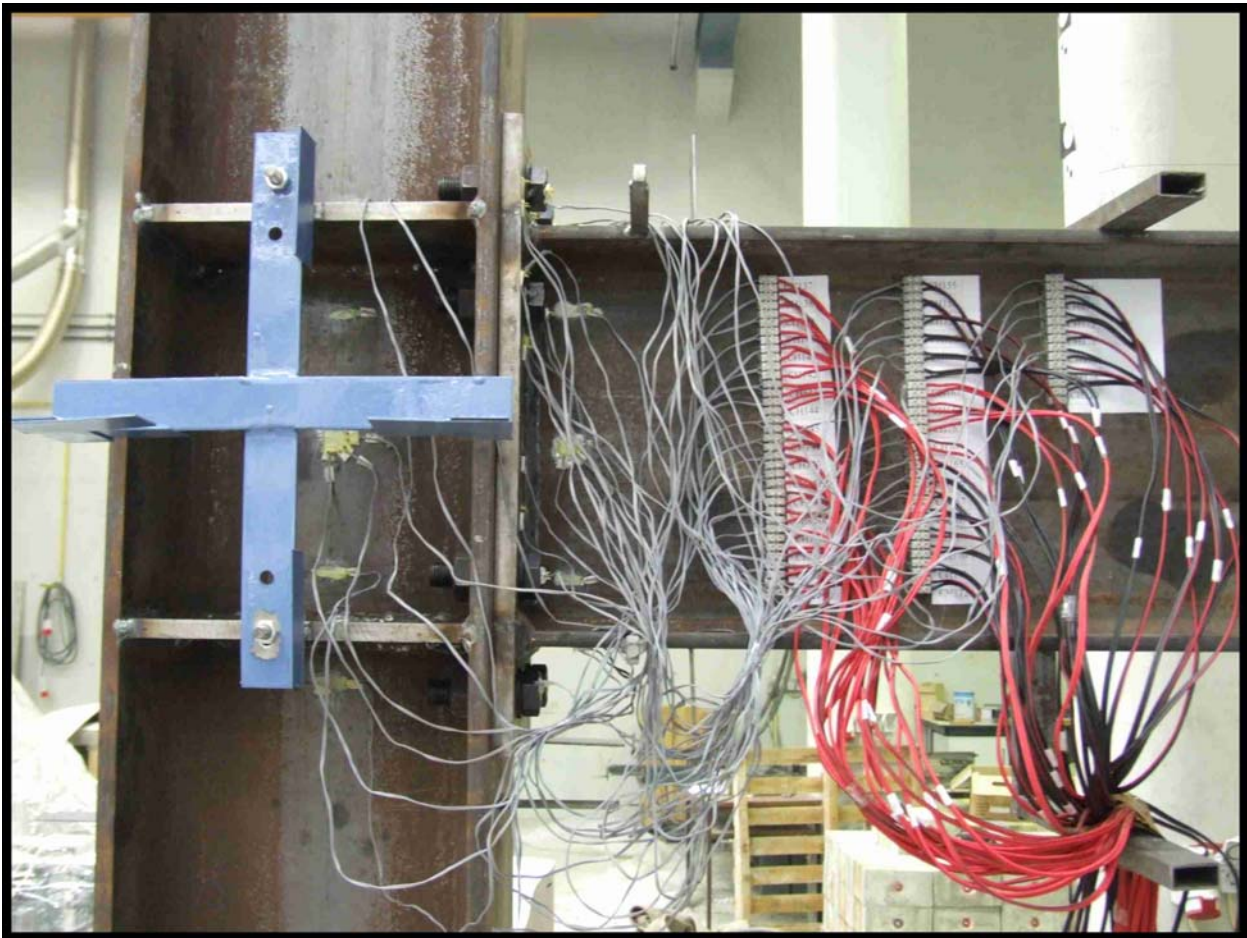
Ilustração geral da aplicação e ligação dos extensómetros eléctricos e sistema acessório de medição da rotação da ligação.
